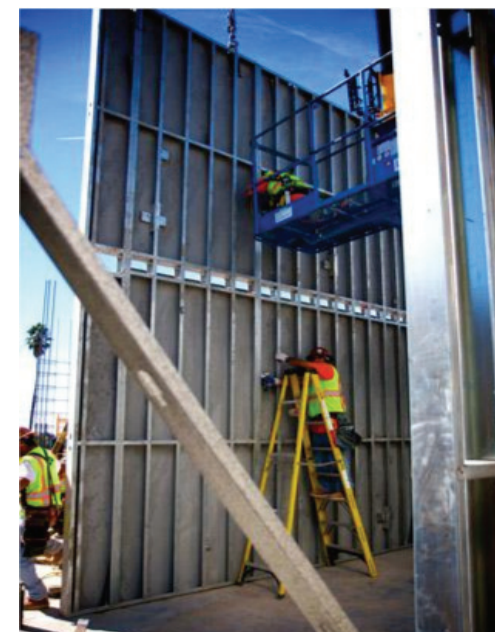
Panel del sistema Ecoliteconcrete donde podemos ver el entramado de acero
